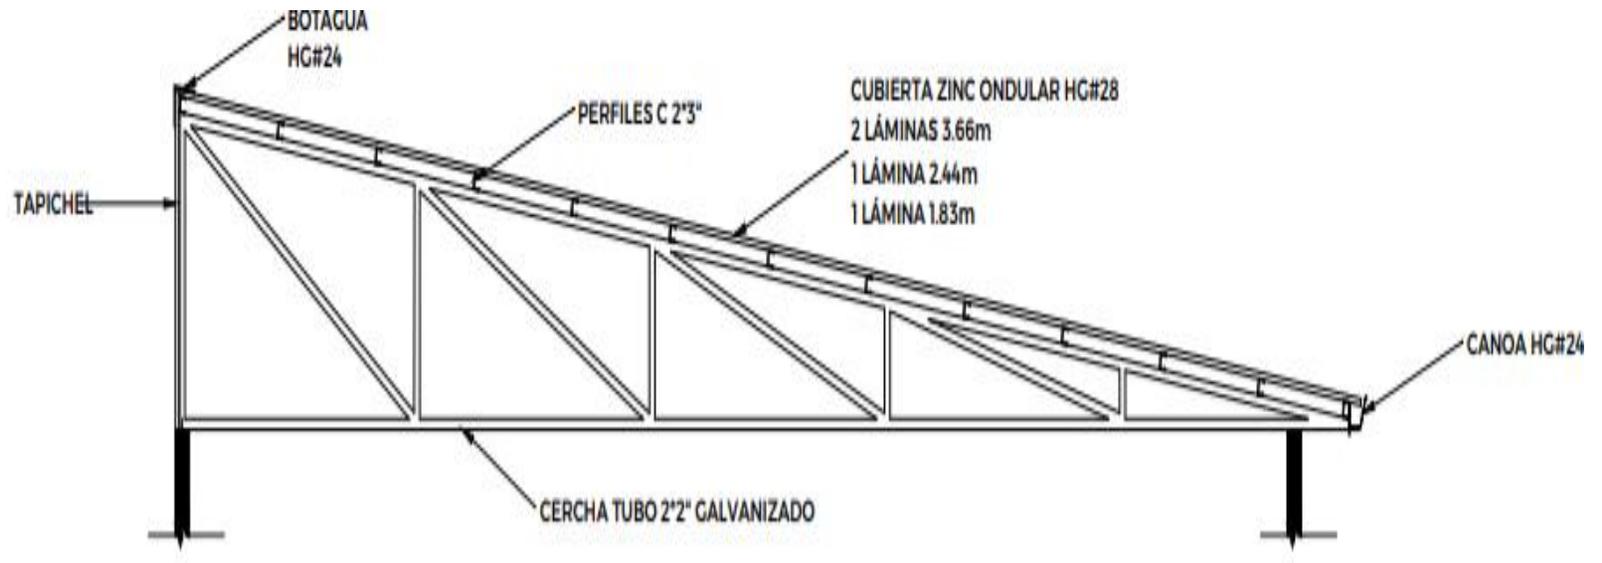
Planta de techos 1 agua - Sistema constructivo Prefabricado- lamina convencional
